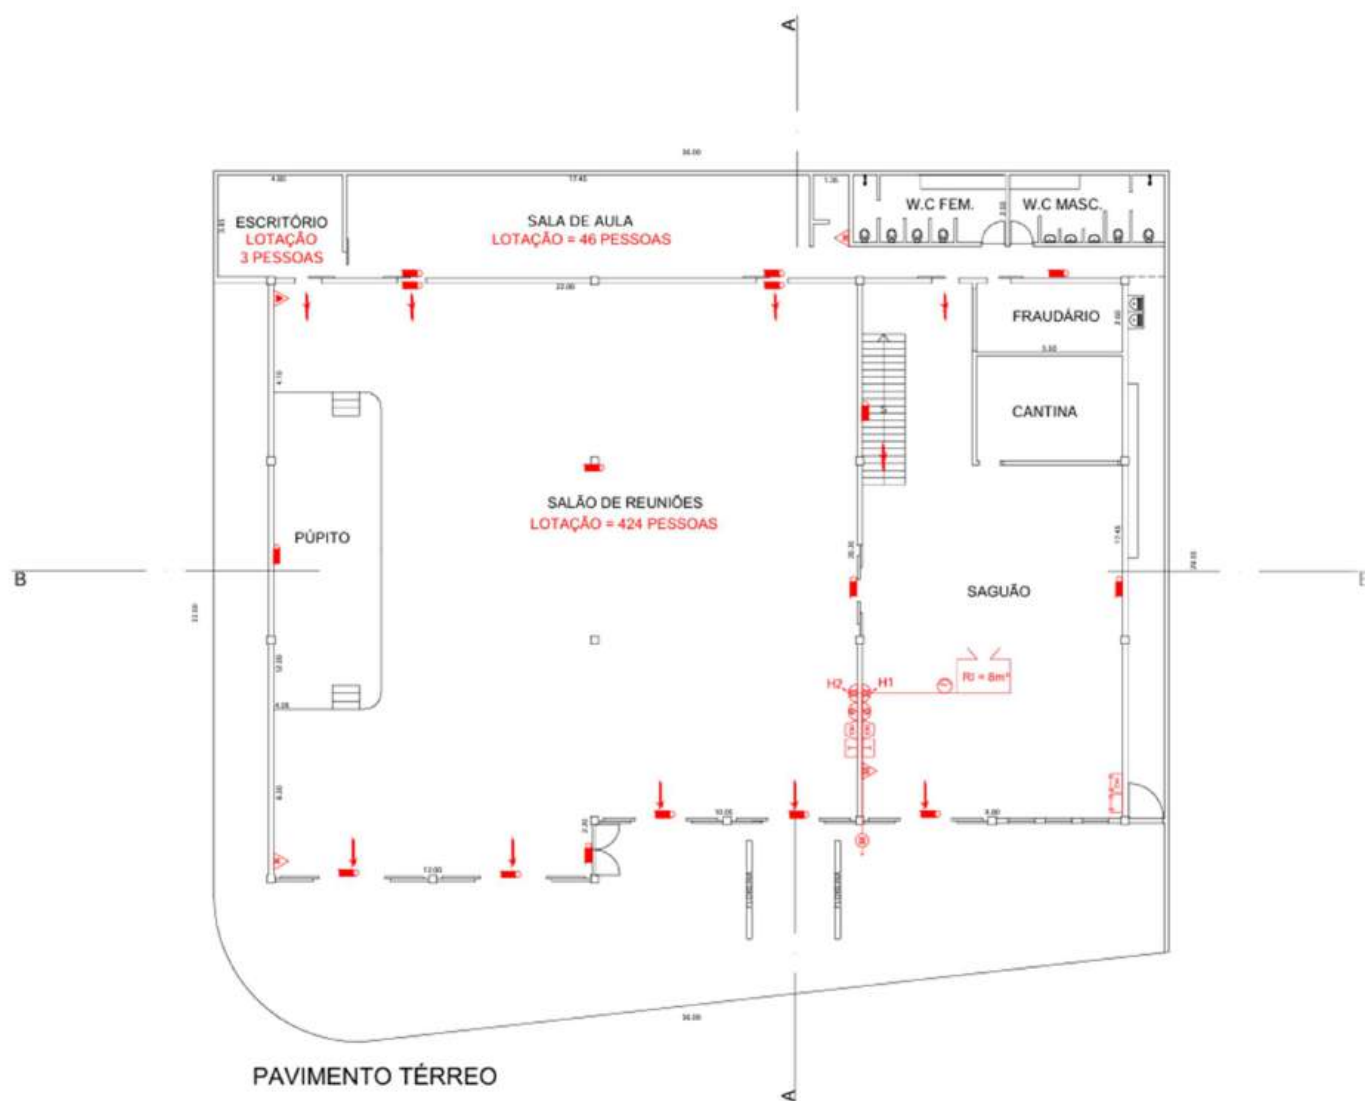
Planta Pavimento Térreo. Fonte: projeto técnico de segurança contra incêndio. Eng^a. Flávia Togni Trezza.
